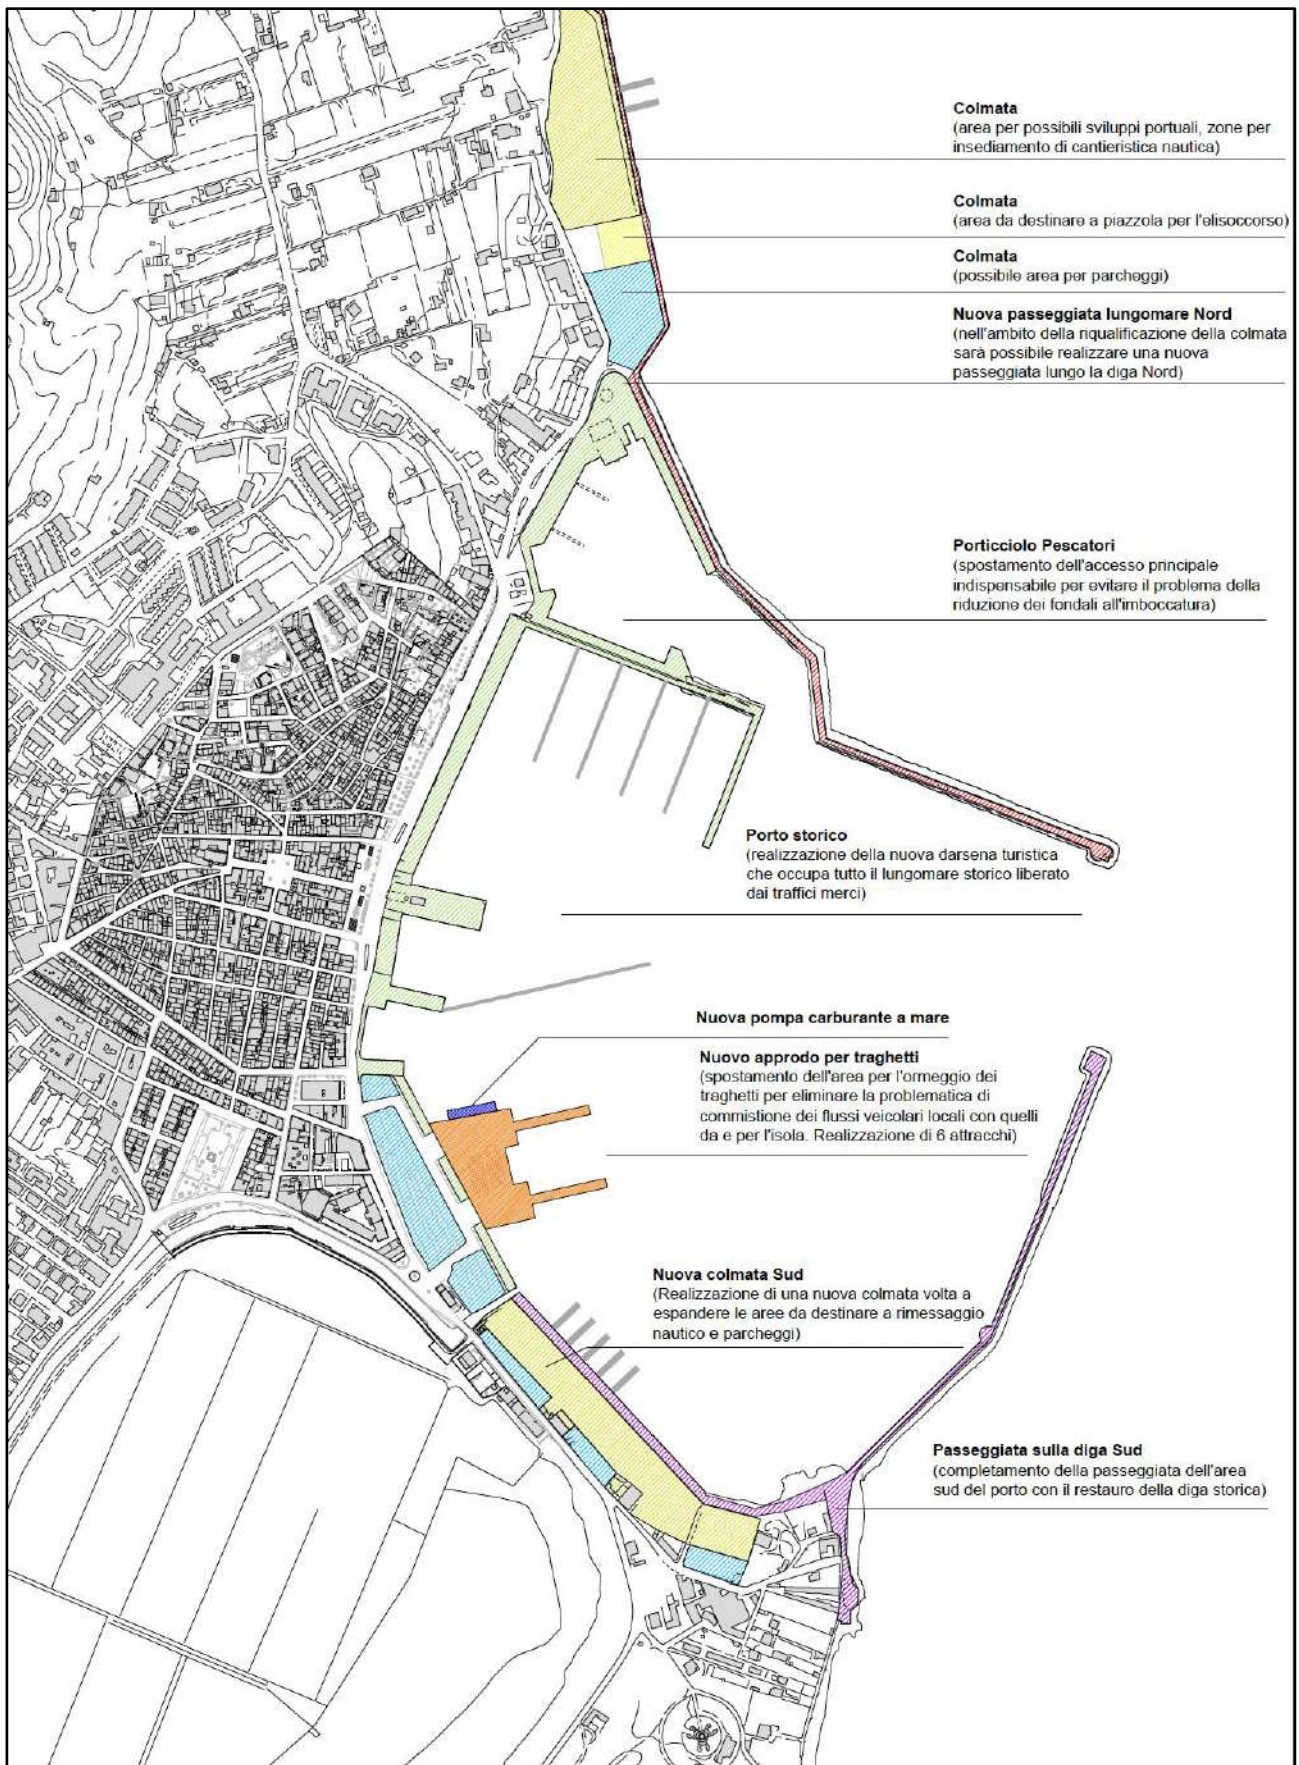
Interventi di potenziamento del Porto di Carloforte – dettaglio planimetria di progetto
